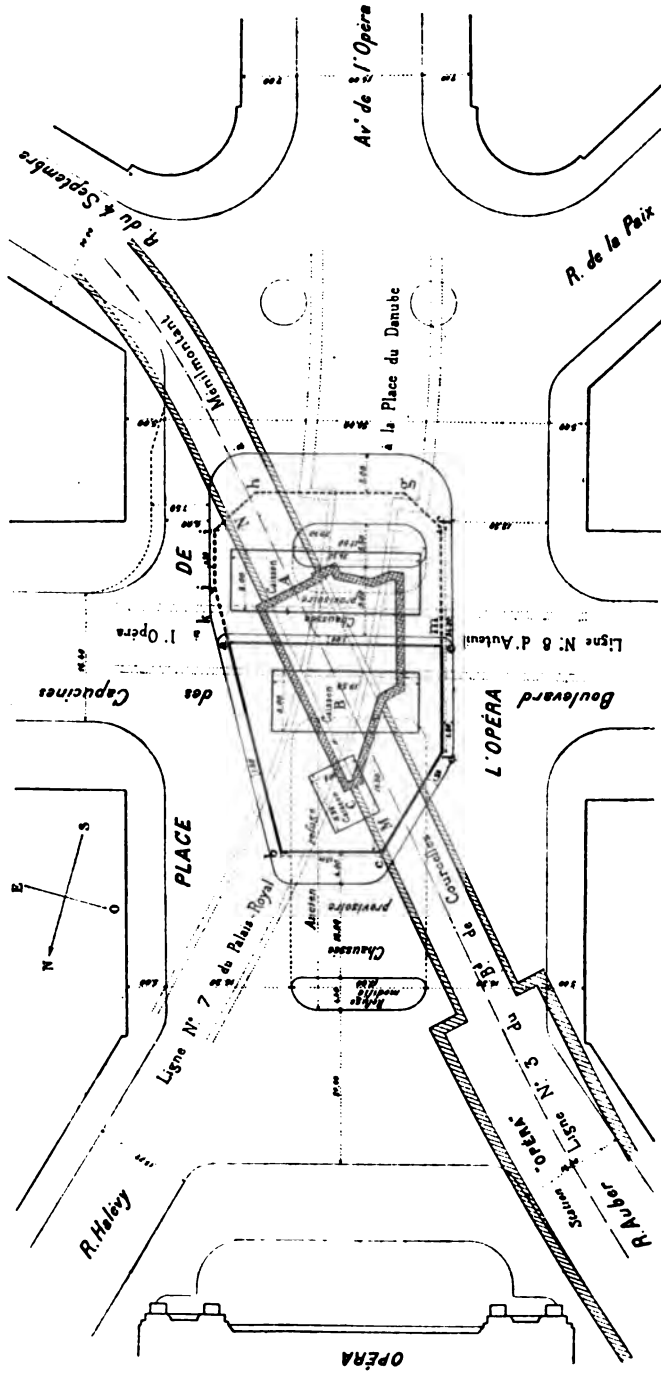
Ouvrage spécial de la place de l'Opéra. Plan général du chantier de construction.
